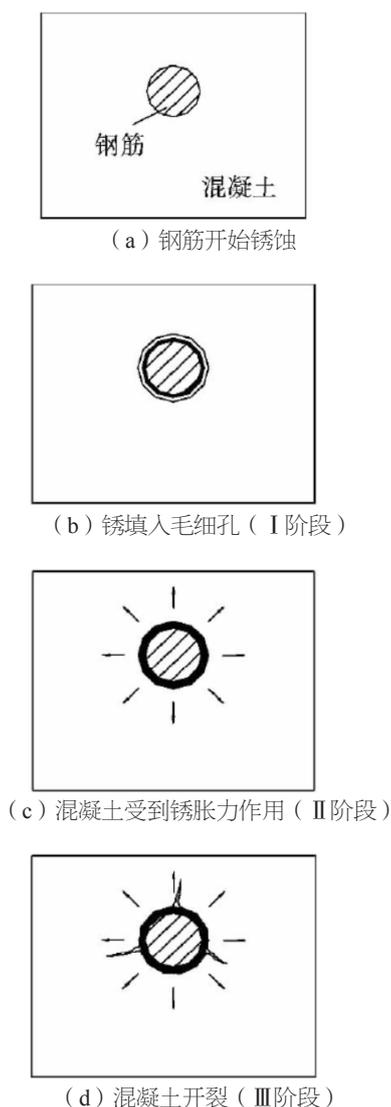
钢筋锈蚀混凝土开裂阶段
